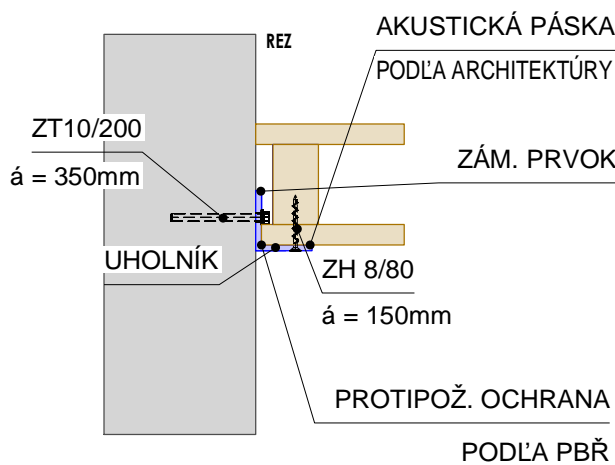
DETAIL "F" - PRIPOJENIE DVOCH STROPNÝCH PANELOV ELEMENT
